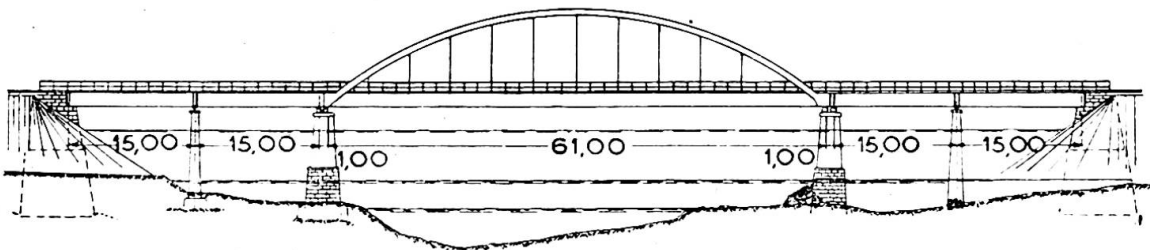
Ansicht der Brücke in vollständig geschweisster Ausführung.
